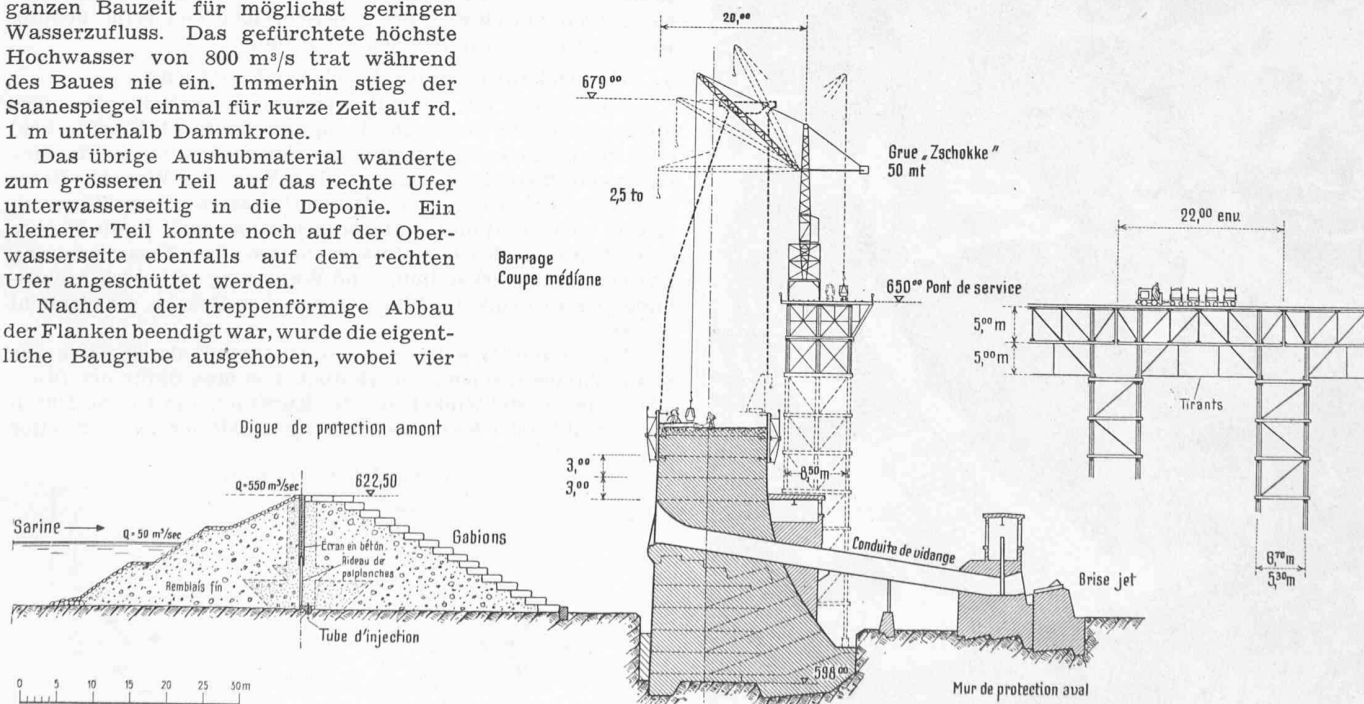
Oberwasserseitiger Abschlussdamm der Baugrube und Betonvorgang der Staumauer, Masstab 1:1000
